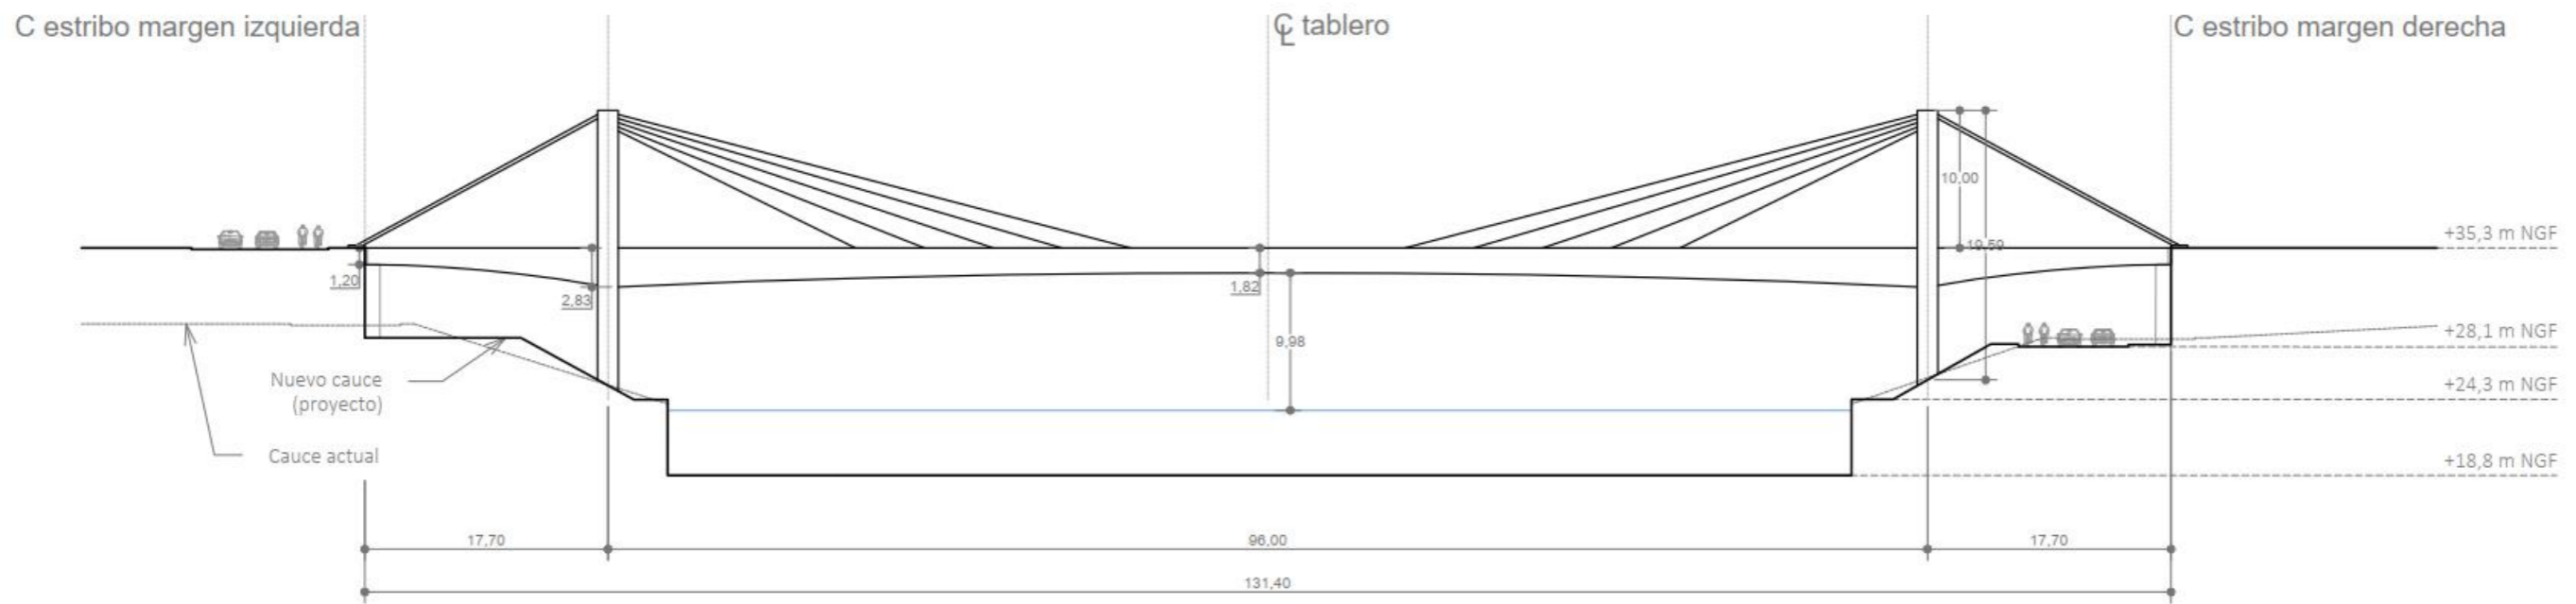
Sección longitudinal alternativa 3 puente atirantado (fuente: elaboración propia)
